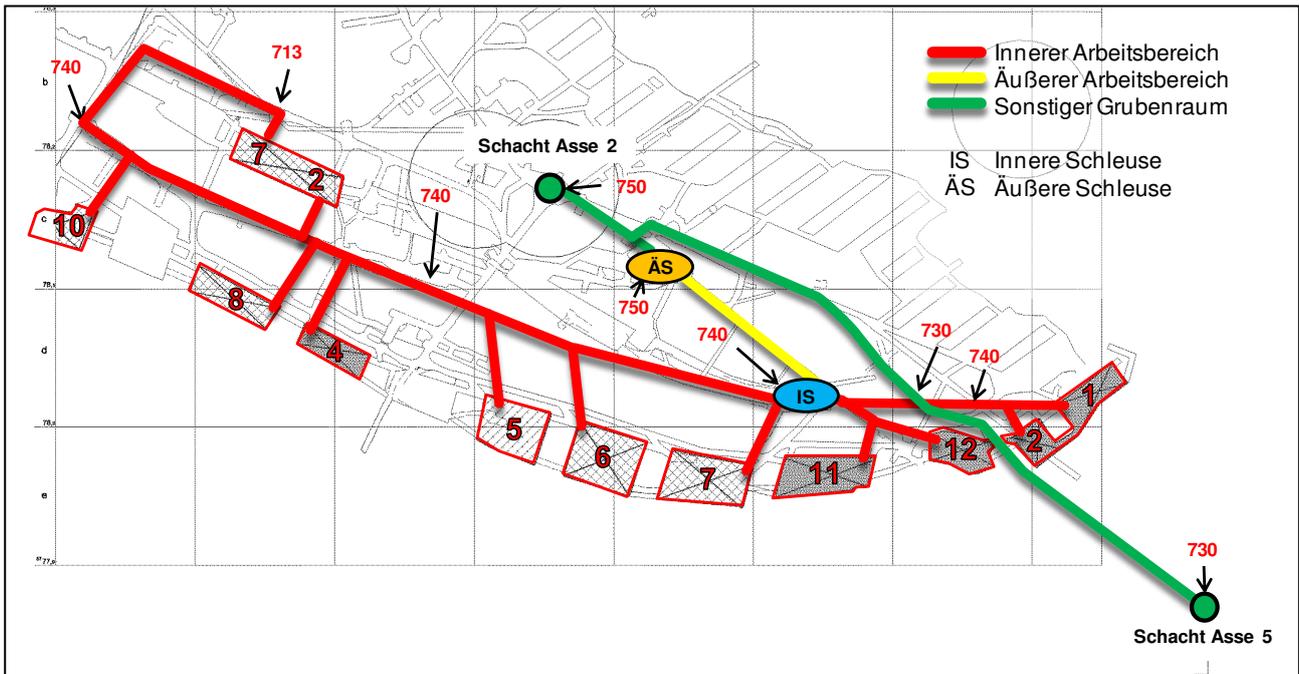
Schematische Darstellung der Variante 1 – Rückholung von Norden von der 750-m-Sohle (Hintergrund: Grundriss der 750-m-Sohle)
